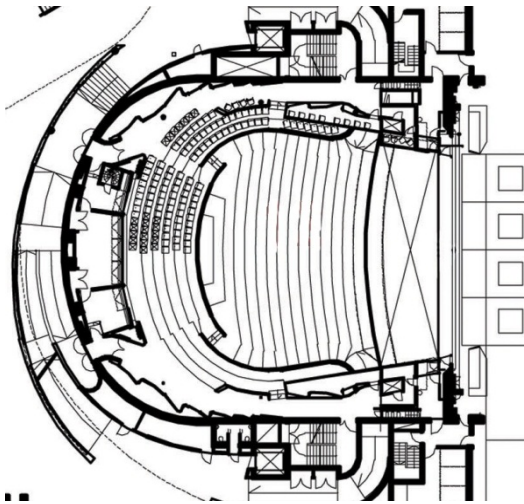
Grundriss Opera Oslo Ausschnitt (Staatsoper Oslo 01.12.2005)
